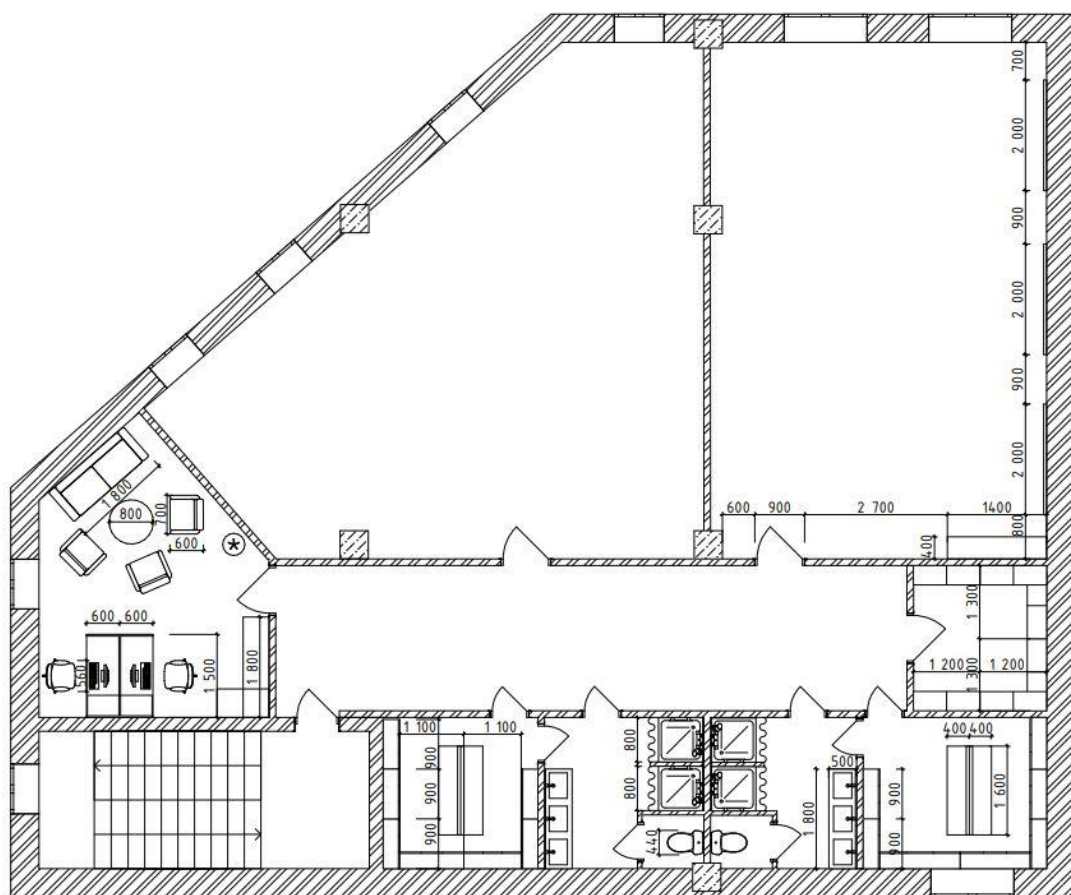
План 2 этажа с расстановкой оборудования
